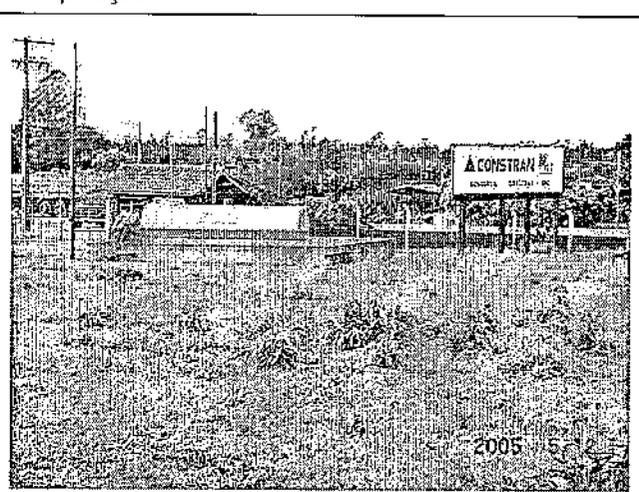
Canteiro de obras da Constran com tanque de combustível ao fundo.
